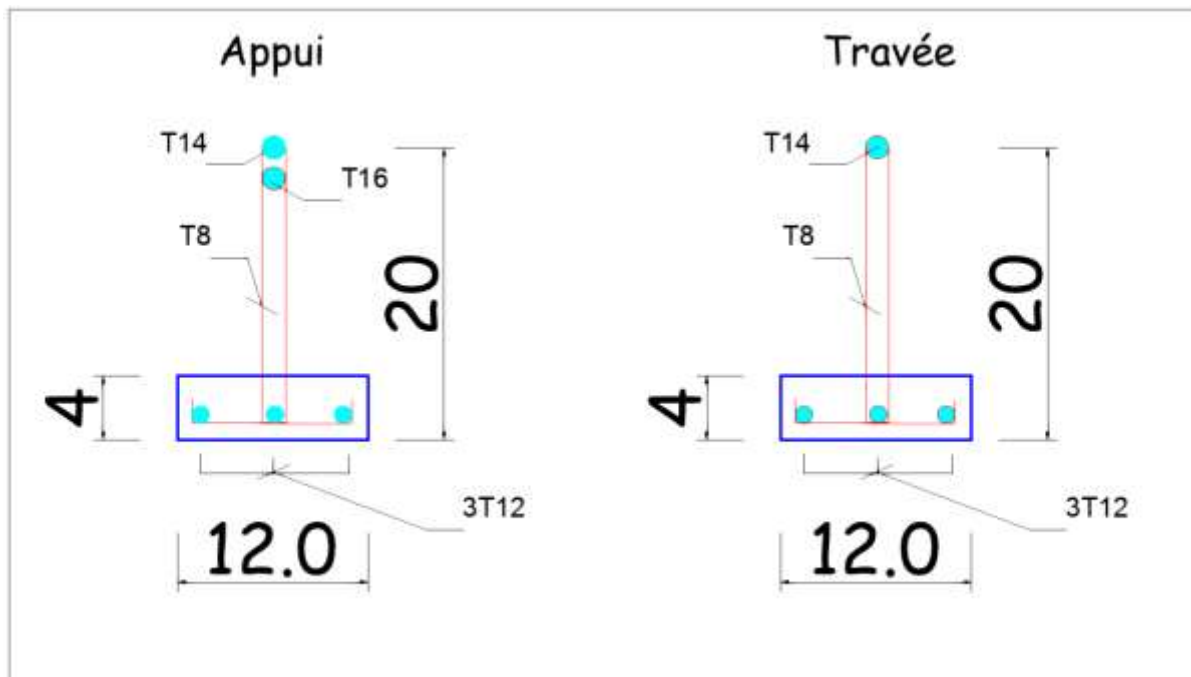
Ferrailage des poutrelles en Travée et en Appuis.
